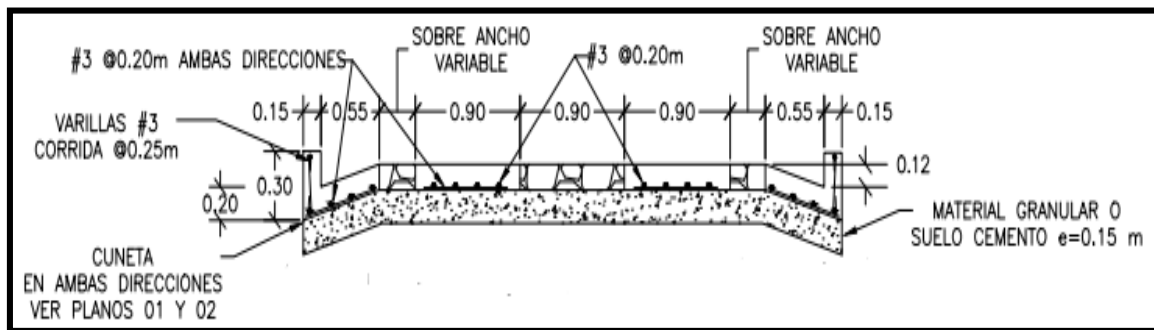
Sección transversal de la placa huella Fuente: Tomado de Cartilla de Obras menores de drenaje y estructuras viales del Instituto Nacional de Vías.
